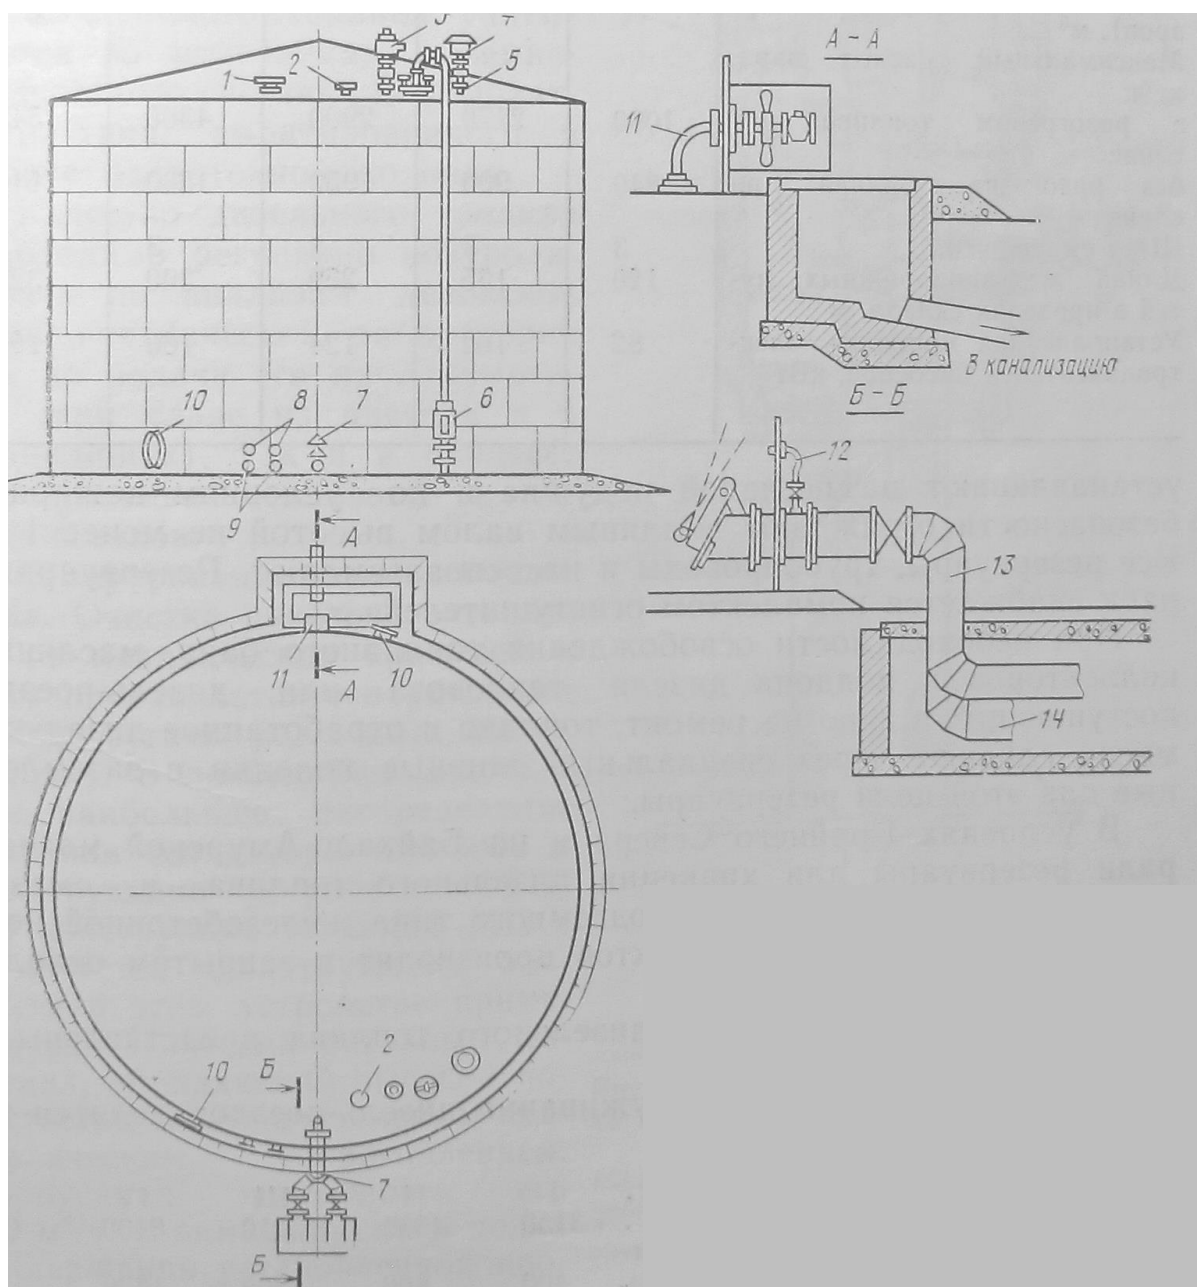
Металлический (сварной) наземный резервуар для хранения дизельного топлива:
